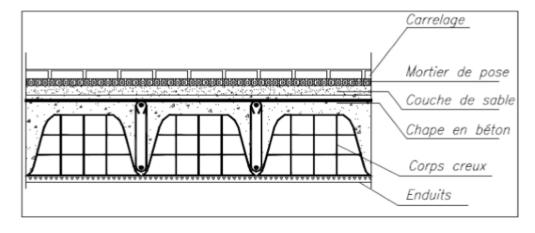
Coupe d'un plancher intermédiaire à corps creux
